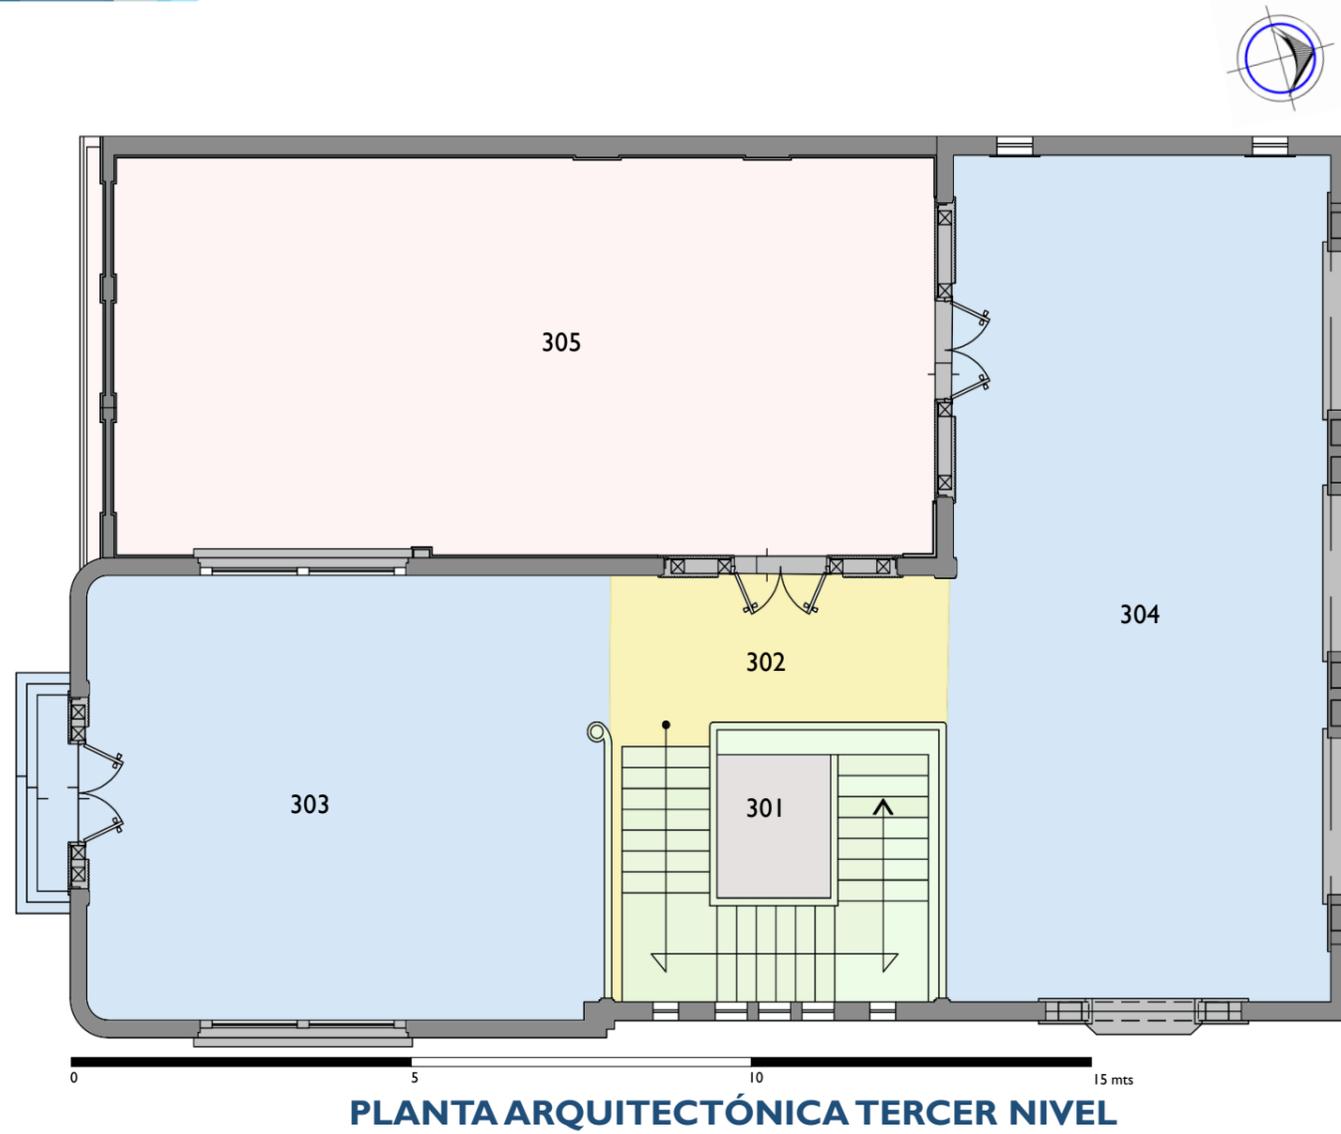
Planta arquitectónica tercer nivel. Fuente: elaboración propia.
